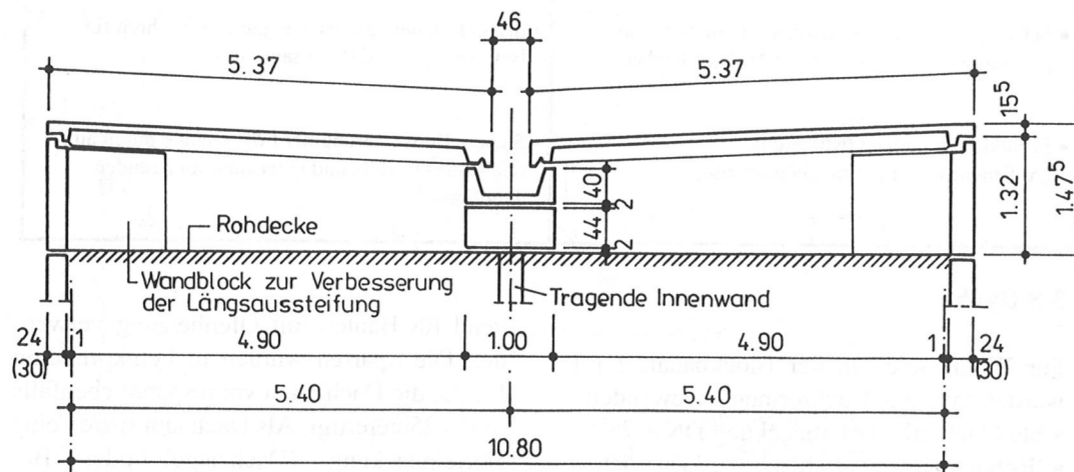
Negativ geneigtes Dach mit Innenentwässerung
